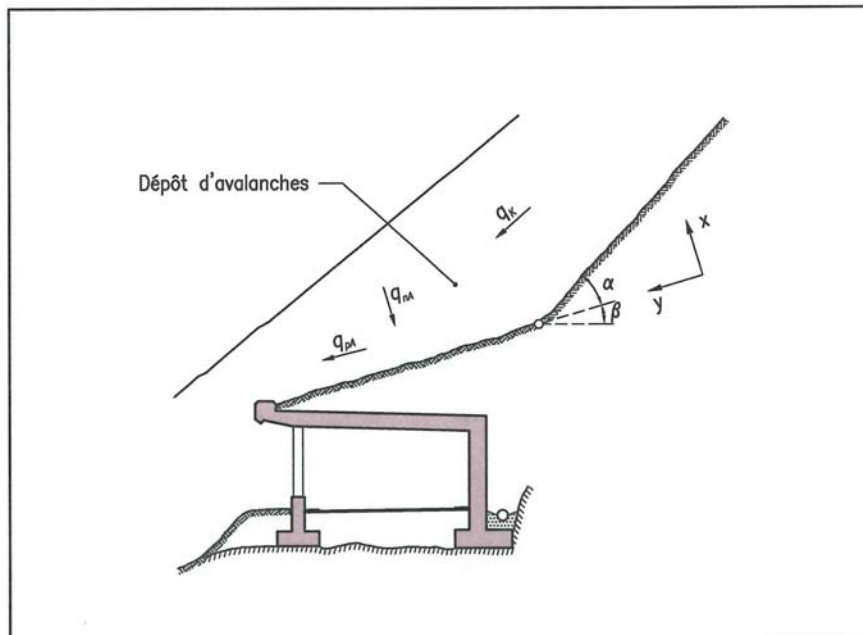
Cas 7, pressions de rampement sur le toit de la galerie.
